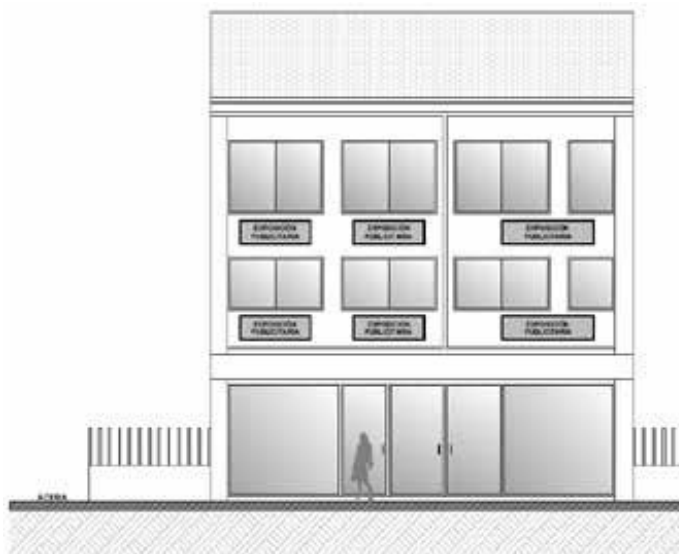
Tipo F – En Fachada. - En predios edificados o en proceso de edificación
